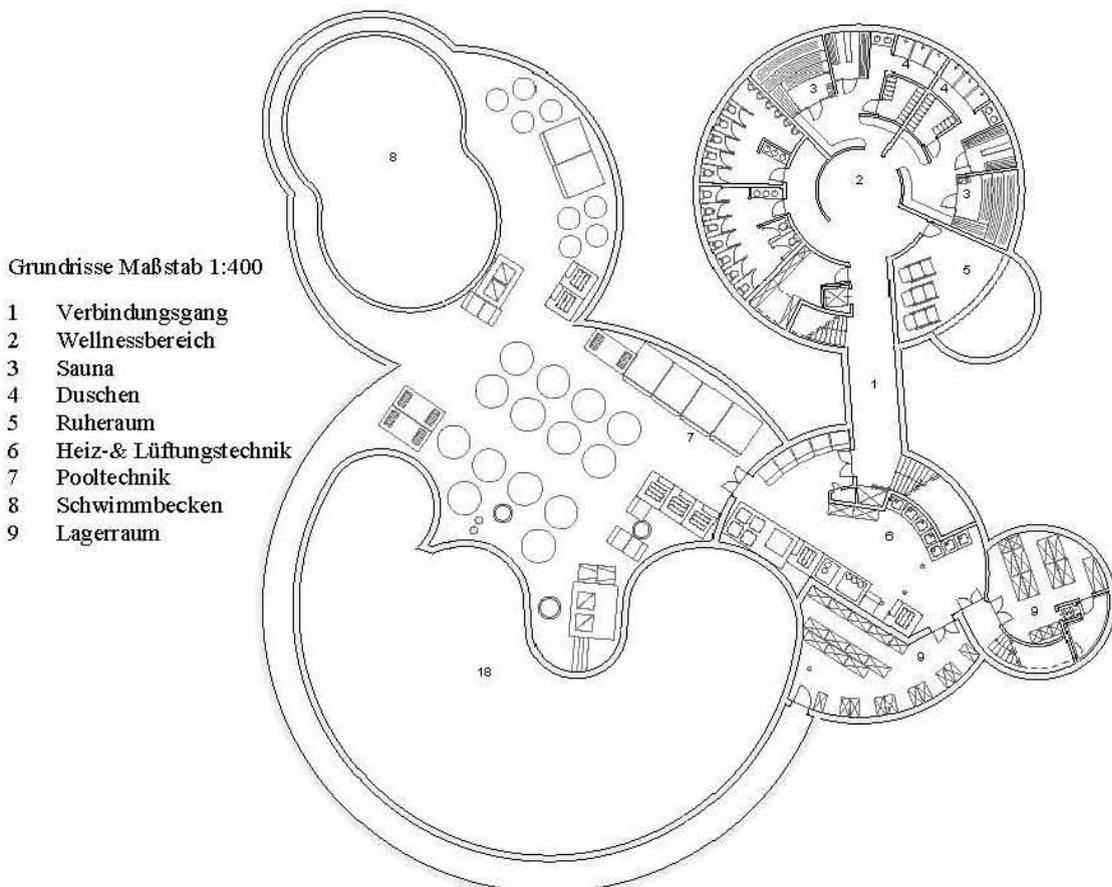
Kellergeschoss Hallenbad / Wellness und Technikbereich
